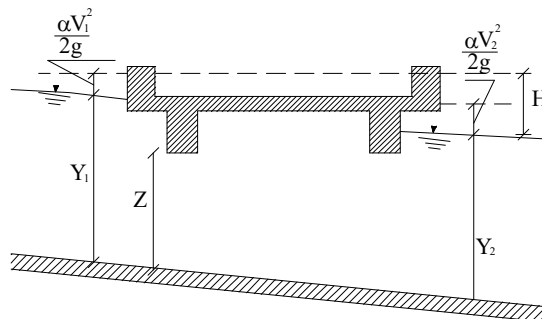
Sezione schematica di un ponte – Schema di calcolo
